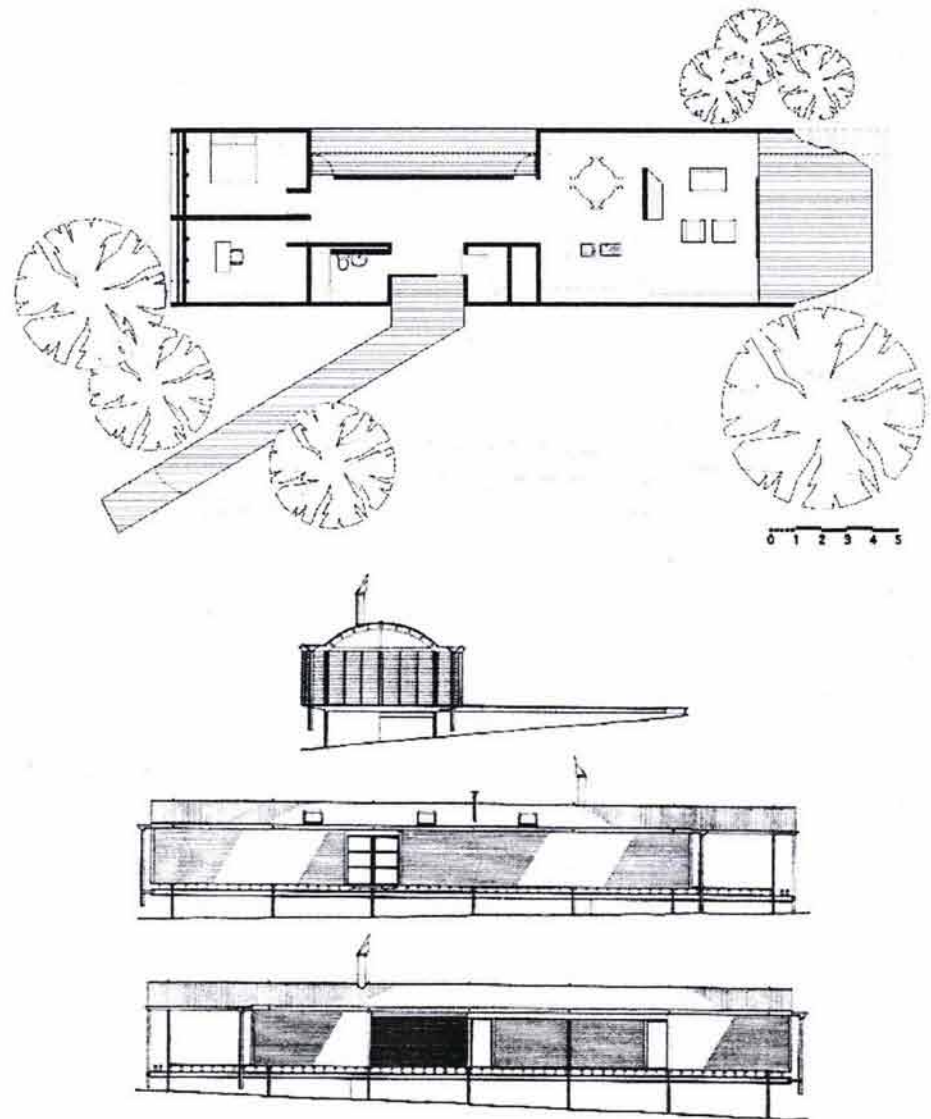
Planta y elevaciones Casa Ball-Eastway. Glenn Murcutt
